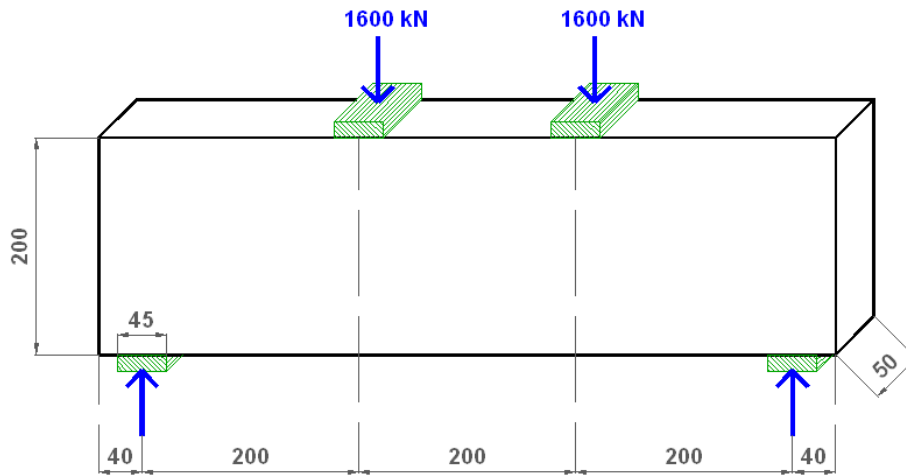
Exemplo de Viga-parede (adaptado de SOUZA, 2004)
